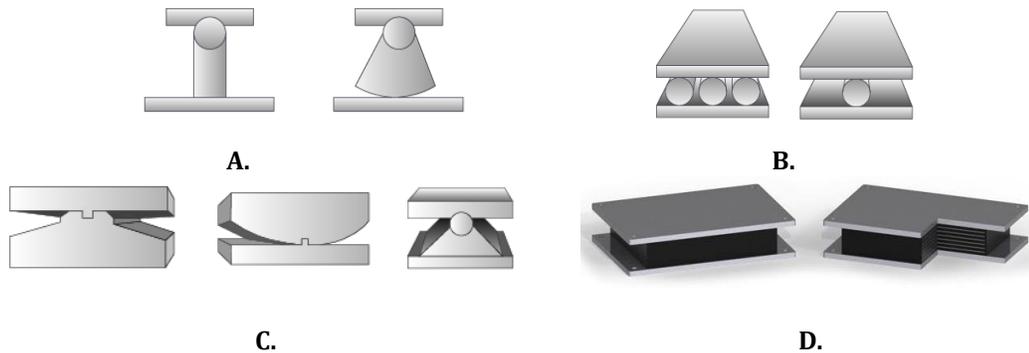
Tipo de apoyos en puentes. A- Apoyo tipo balancín, B- Apoyo tipo rodillo, C- Apoyo fijo, D- Placas de neopreno.
